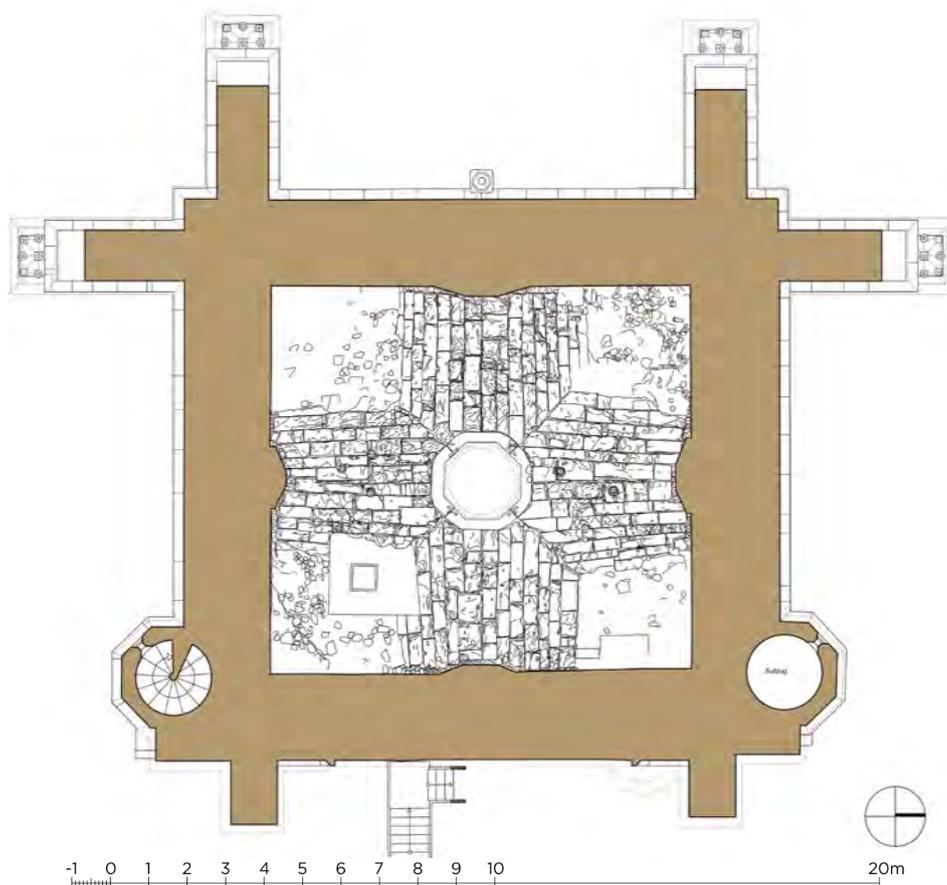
Grundriss oberhalb dem Gewölbe der Michaelskapelle
